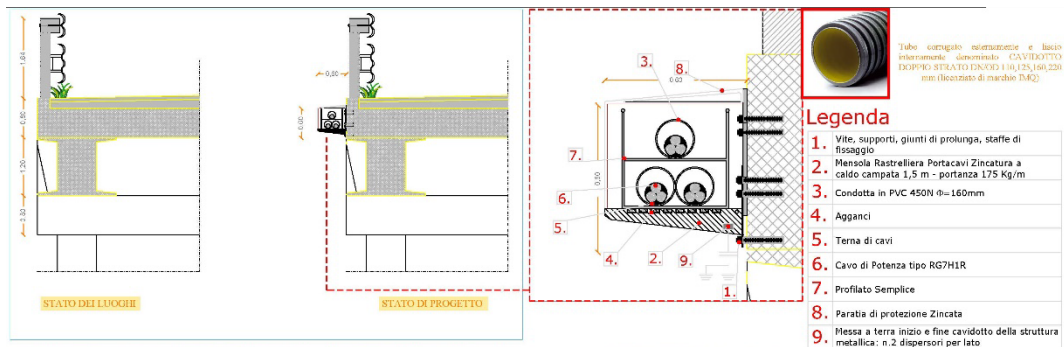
Schema tipo di Attraversamento (su spalla Ponte)
